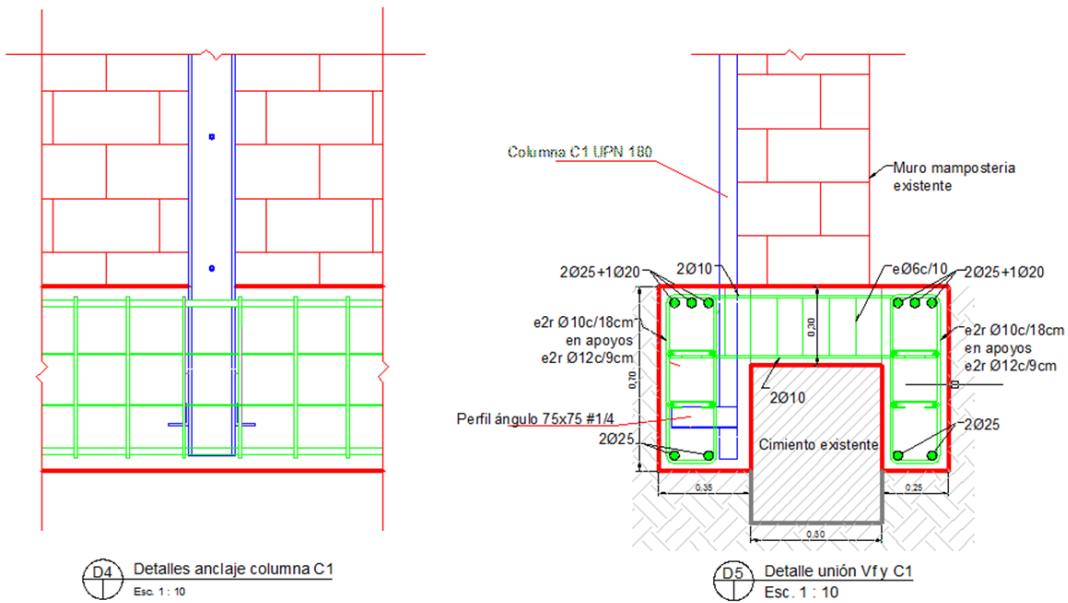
Detalle de anclaje de columnas en fundaciones y unión con vigas
